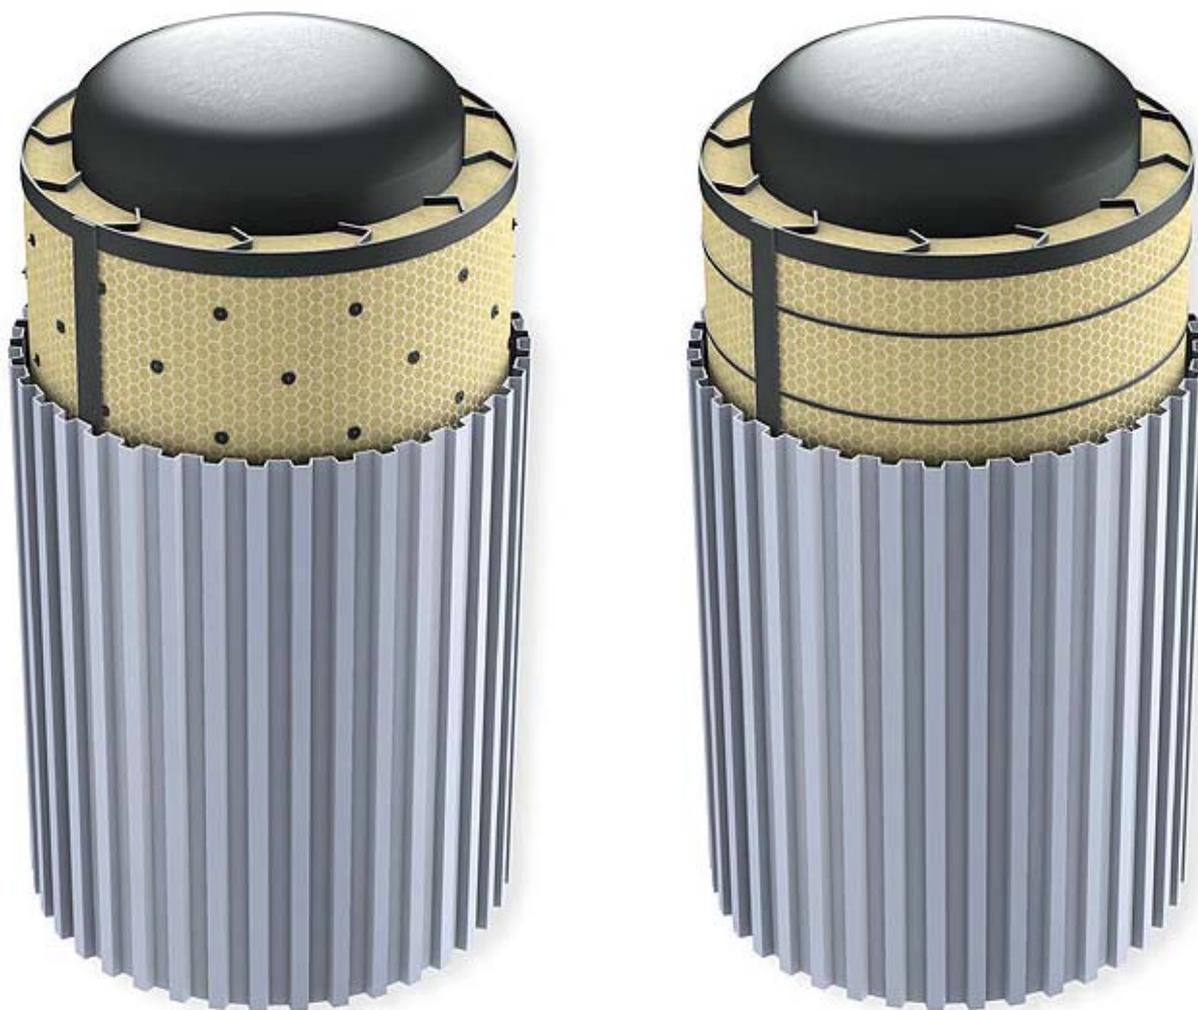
а. Устройство кровли изолируемого резервуара, где опорная конструкция находится сверху плиты кровли резервуара.
